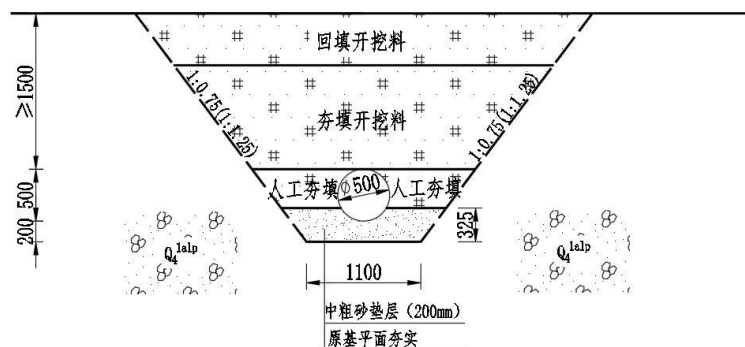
管道基础横断面图（砂砾石地基）
